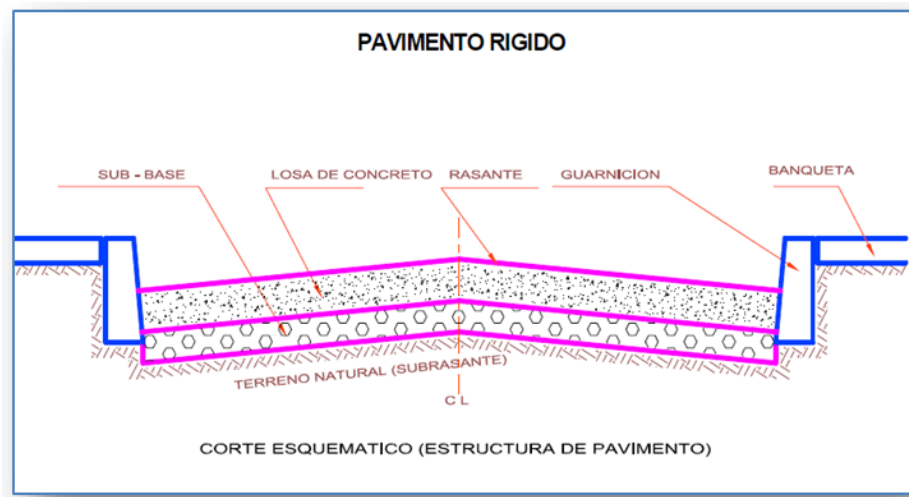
Corte Esquemático con cada una de las Partes de un Pavimento Rígido
